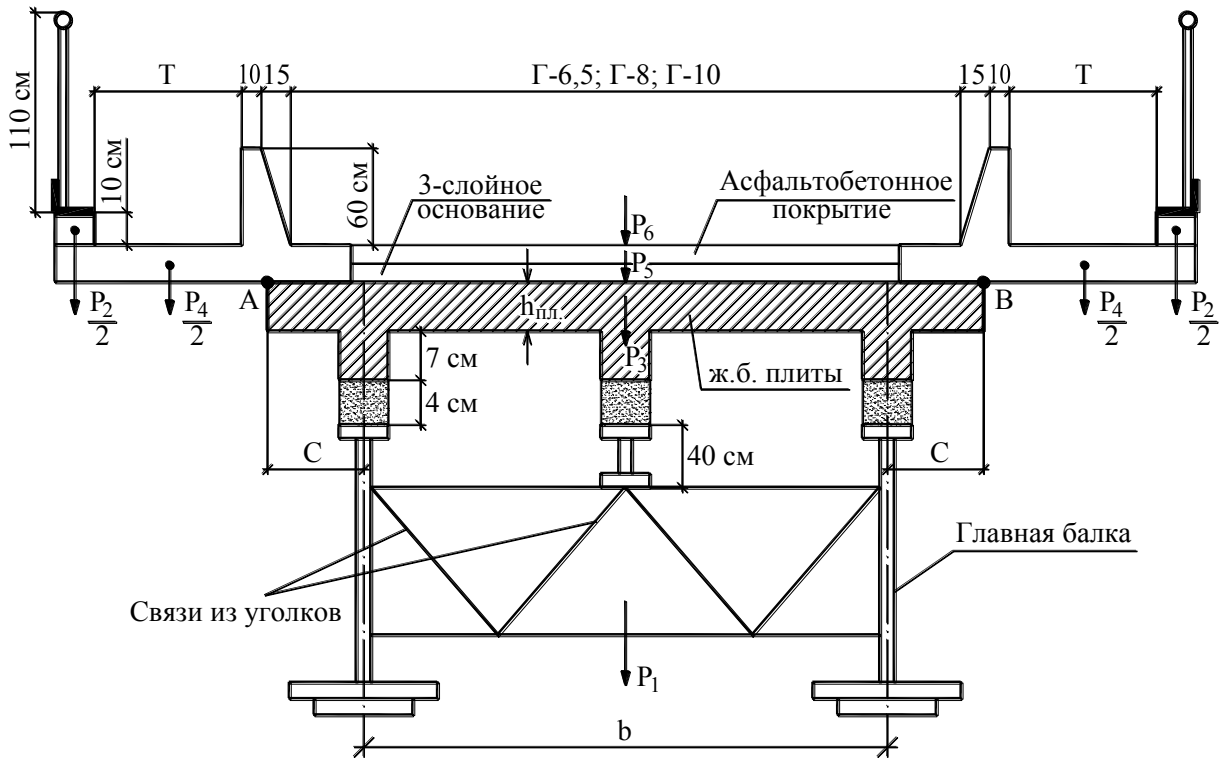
Схематический поперечный разрез сталежелезобетонного пролетного строения для габаритов Г-6,5; Г-8 и Г-10
